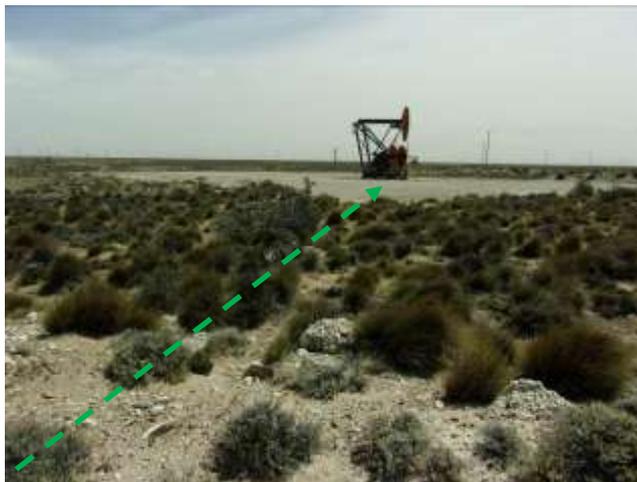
Emplazamiento de línea de inyección por terreno virgen y locación existente. Foto en dirección NE.
